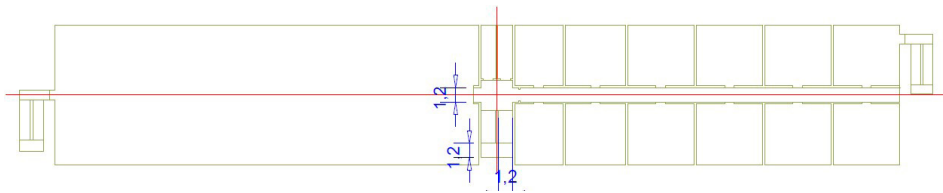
Grundriss einer Ebene im Treppenbereich bei 1,20 m Treppenbreite
